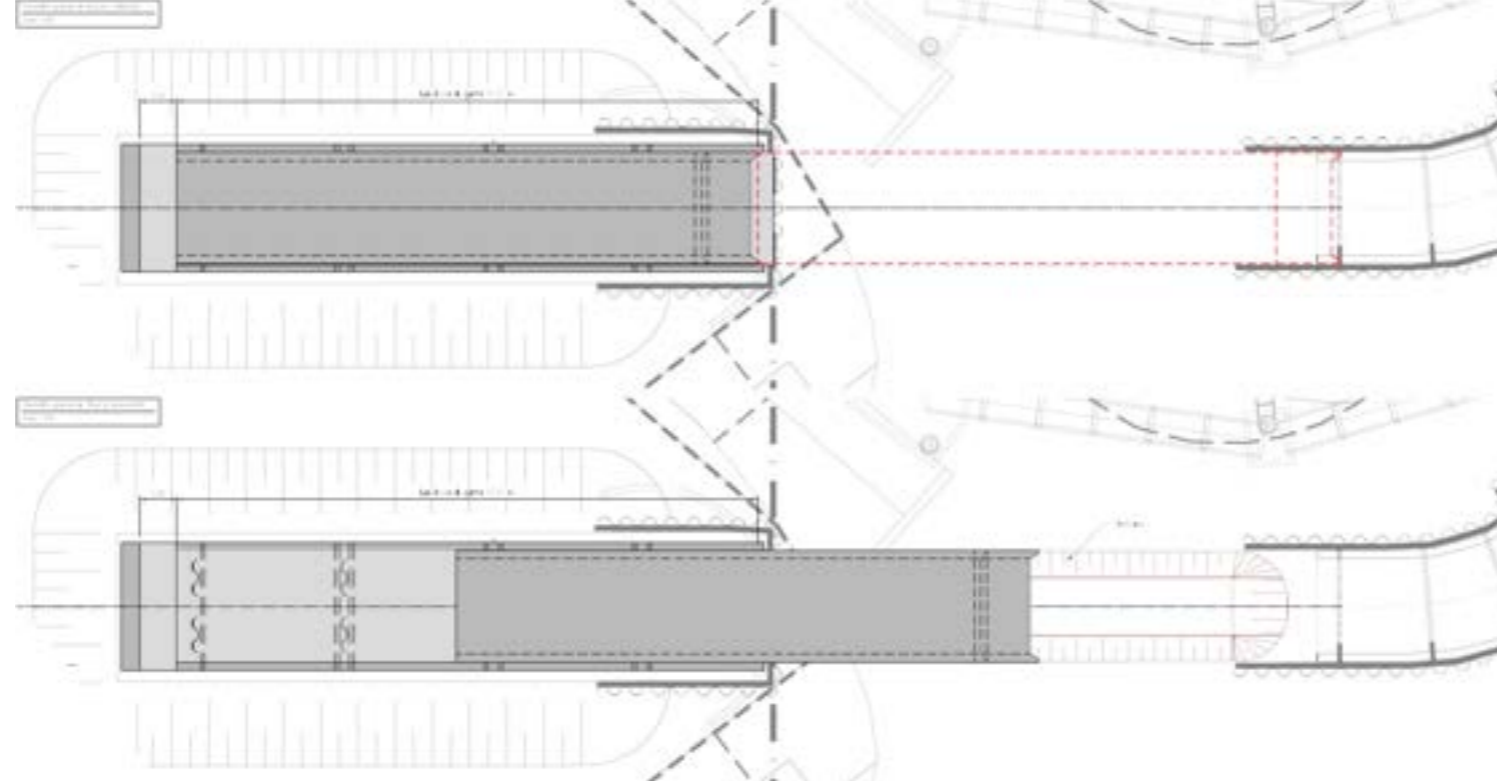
Planimetría con Sistema Verona instalado para hinca de de proyecto
